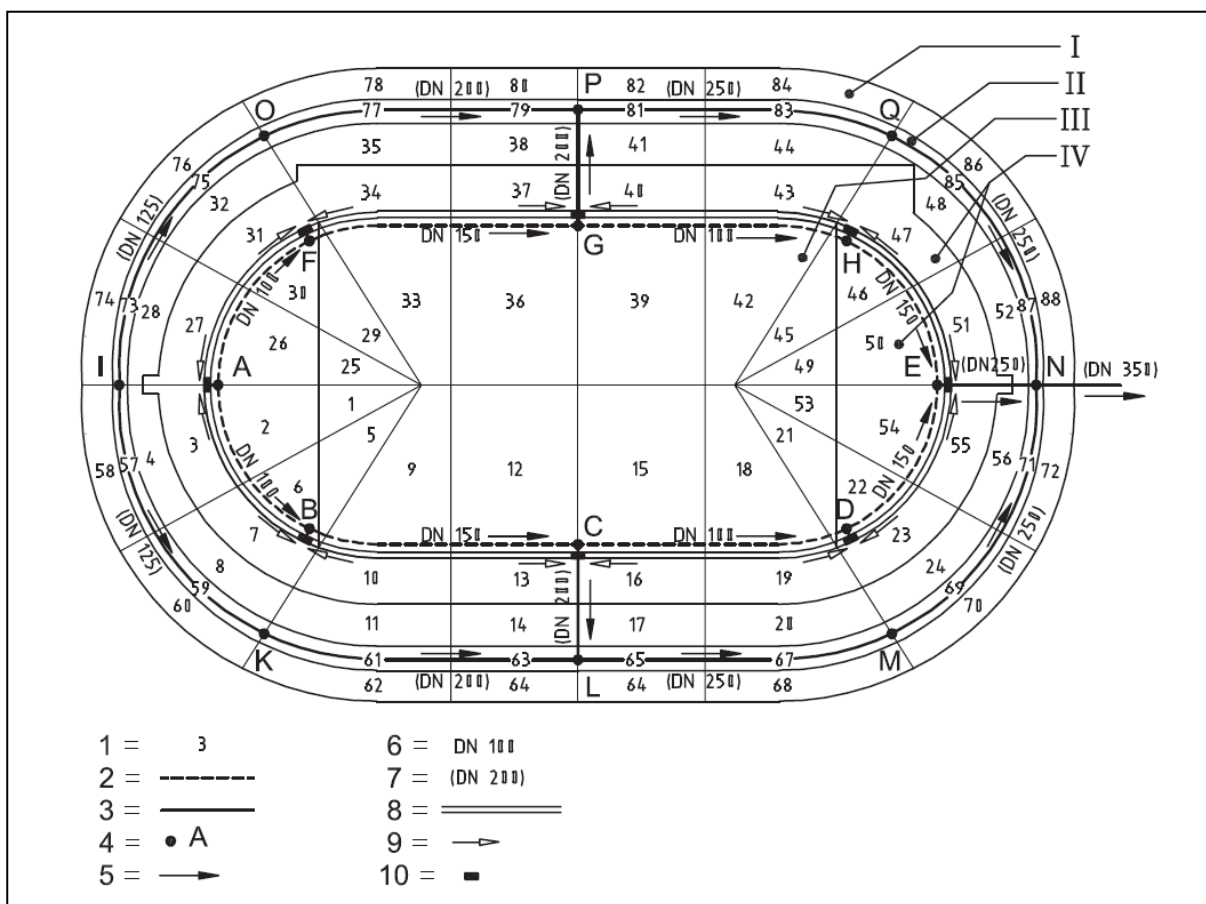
Exemple de calcul du drainage du terrain intérieur d'une installation de compétition (voir aussi le tableau 3.3.5.1)
